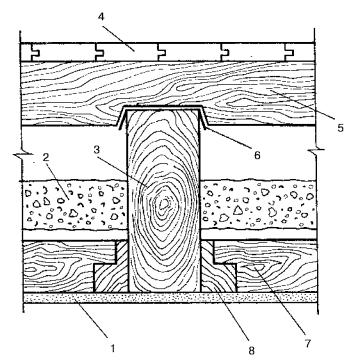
Схема потолочного перекрытия по деревянным балкам:
